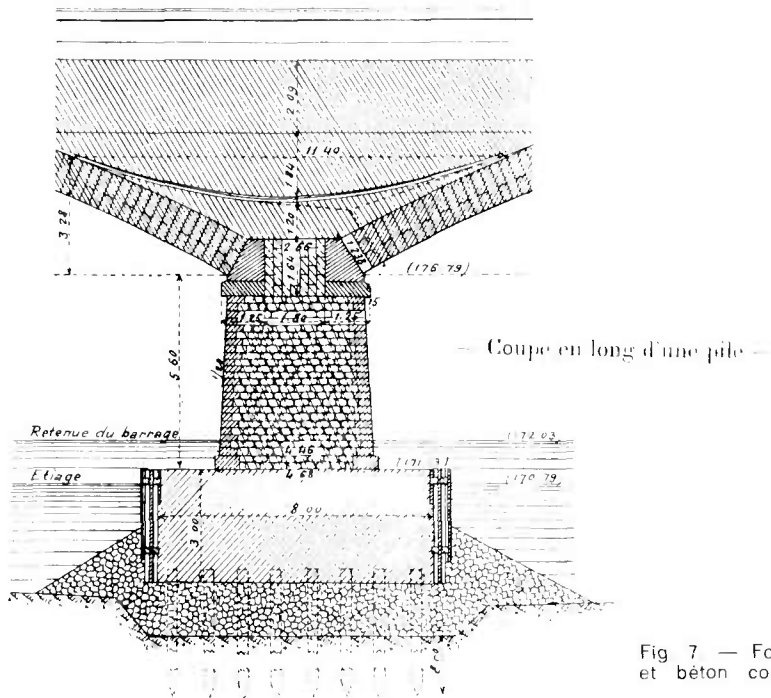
Fondation sur pieux avec suppression du grillage et béton coulé dans un caisson échoué Pont Boucicaut (milieu du XIX<sup>e</sup> siècle).
